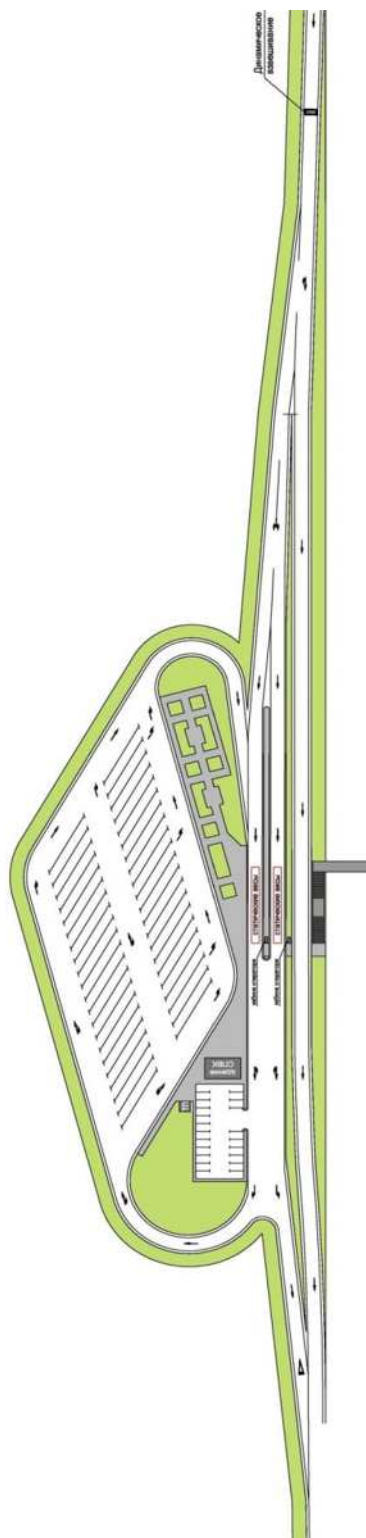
Типовое планировочное решение по СПВК (вариант № 2)
